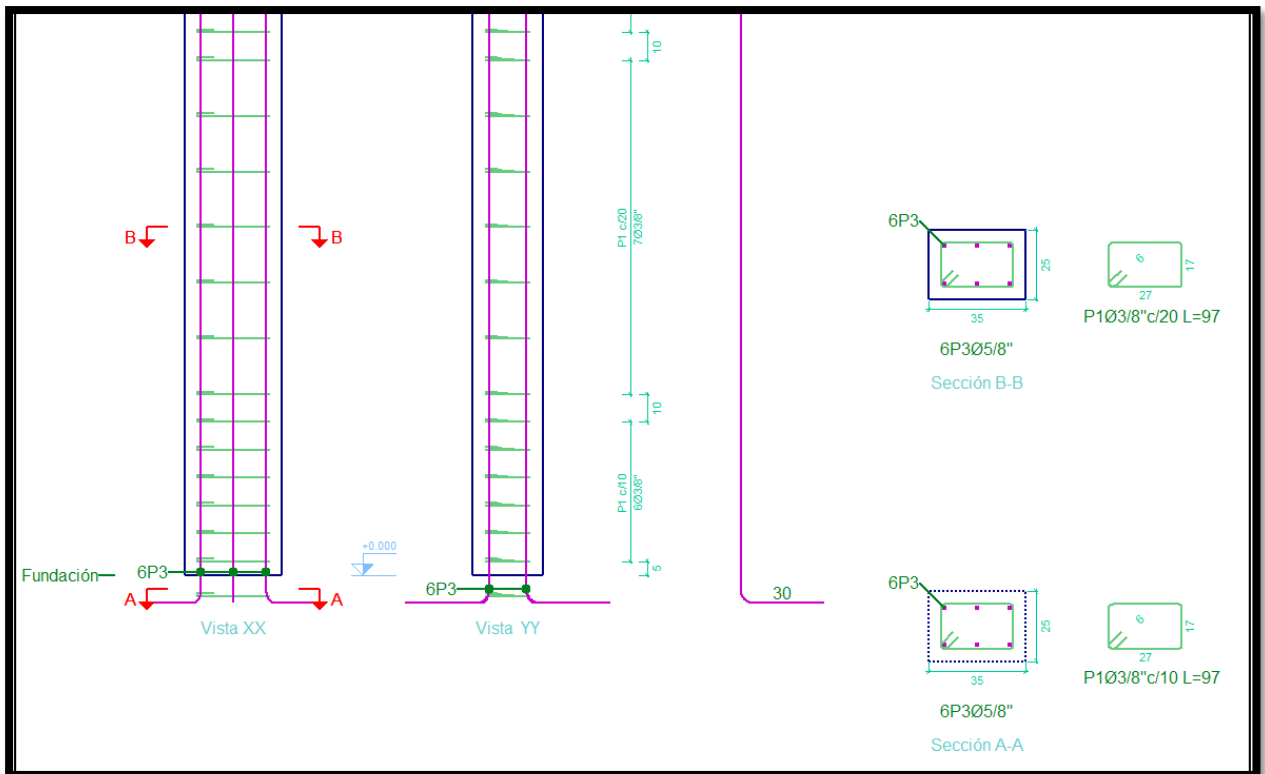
Detalle de columnas de 25x35 módulo 1 y 2.
